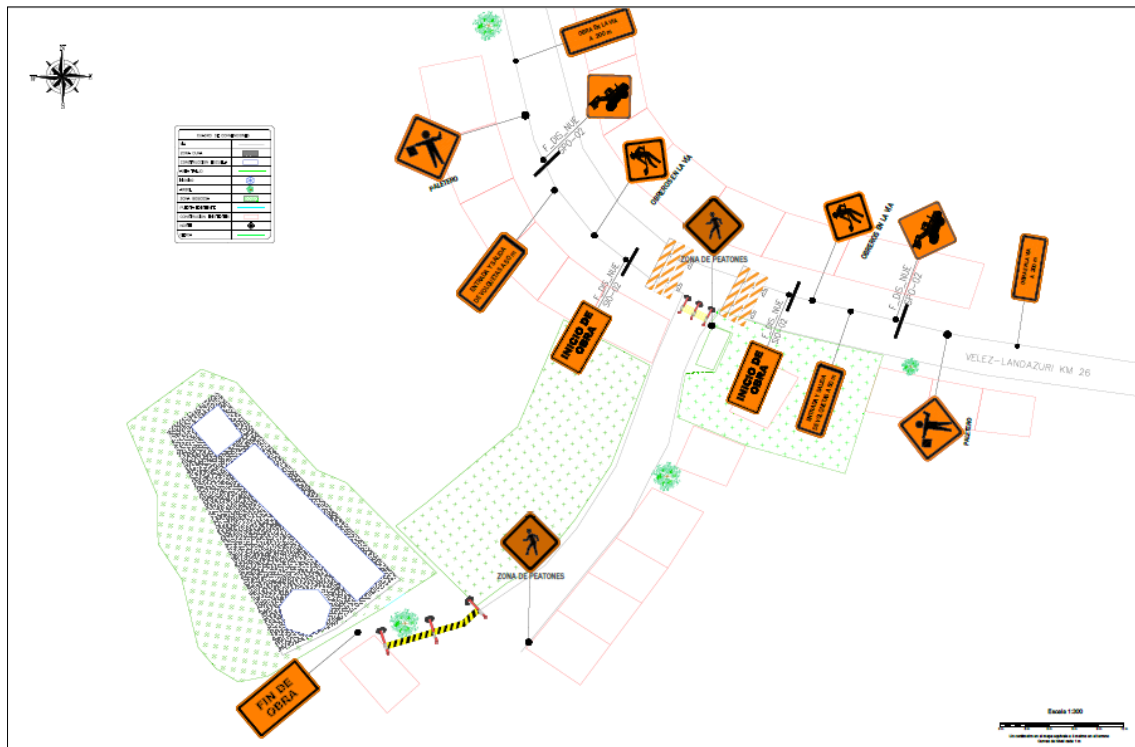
Vista en planta del plan de manejo de tránsito. (AutoCAD, Fuente propia)
